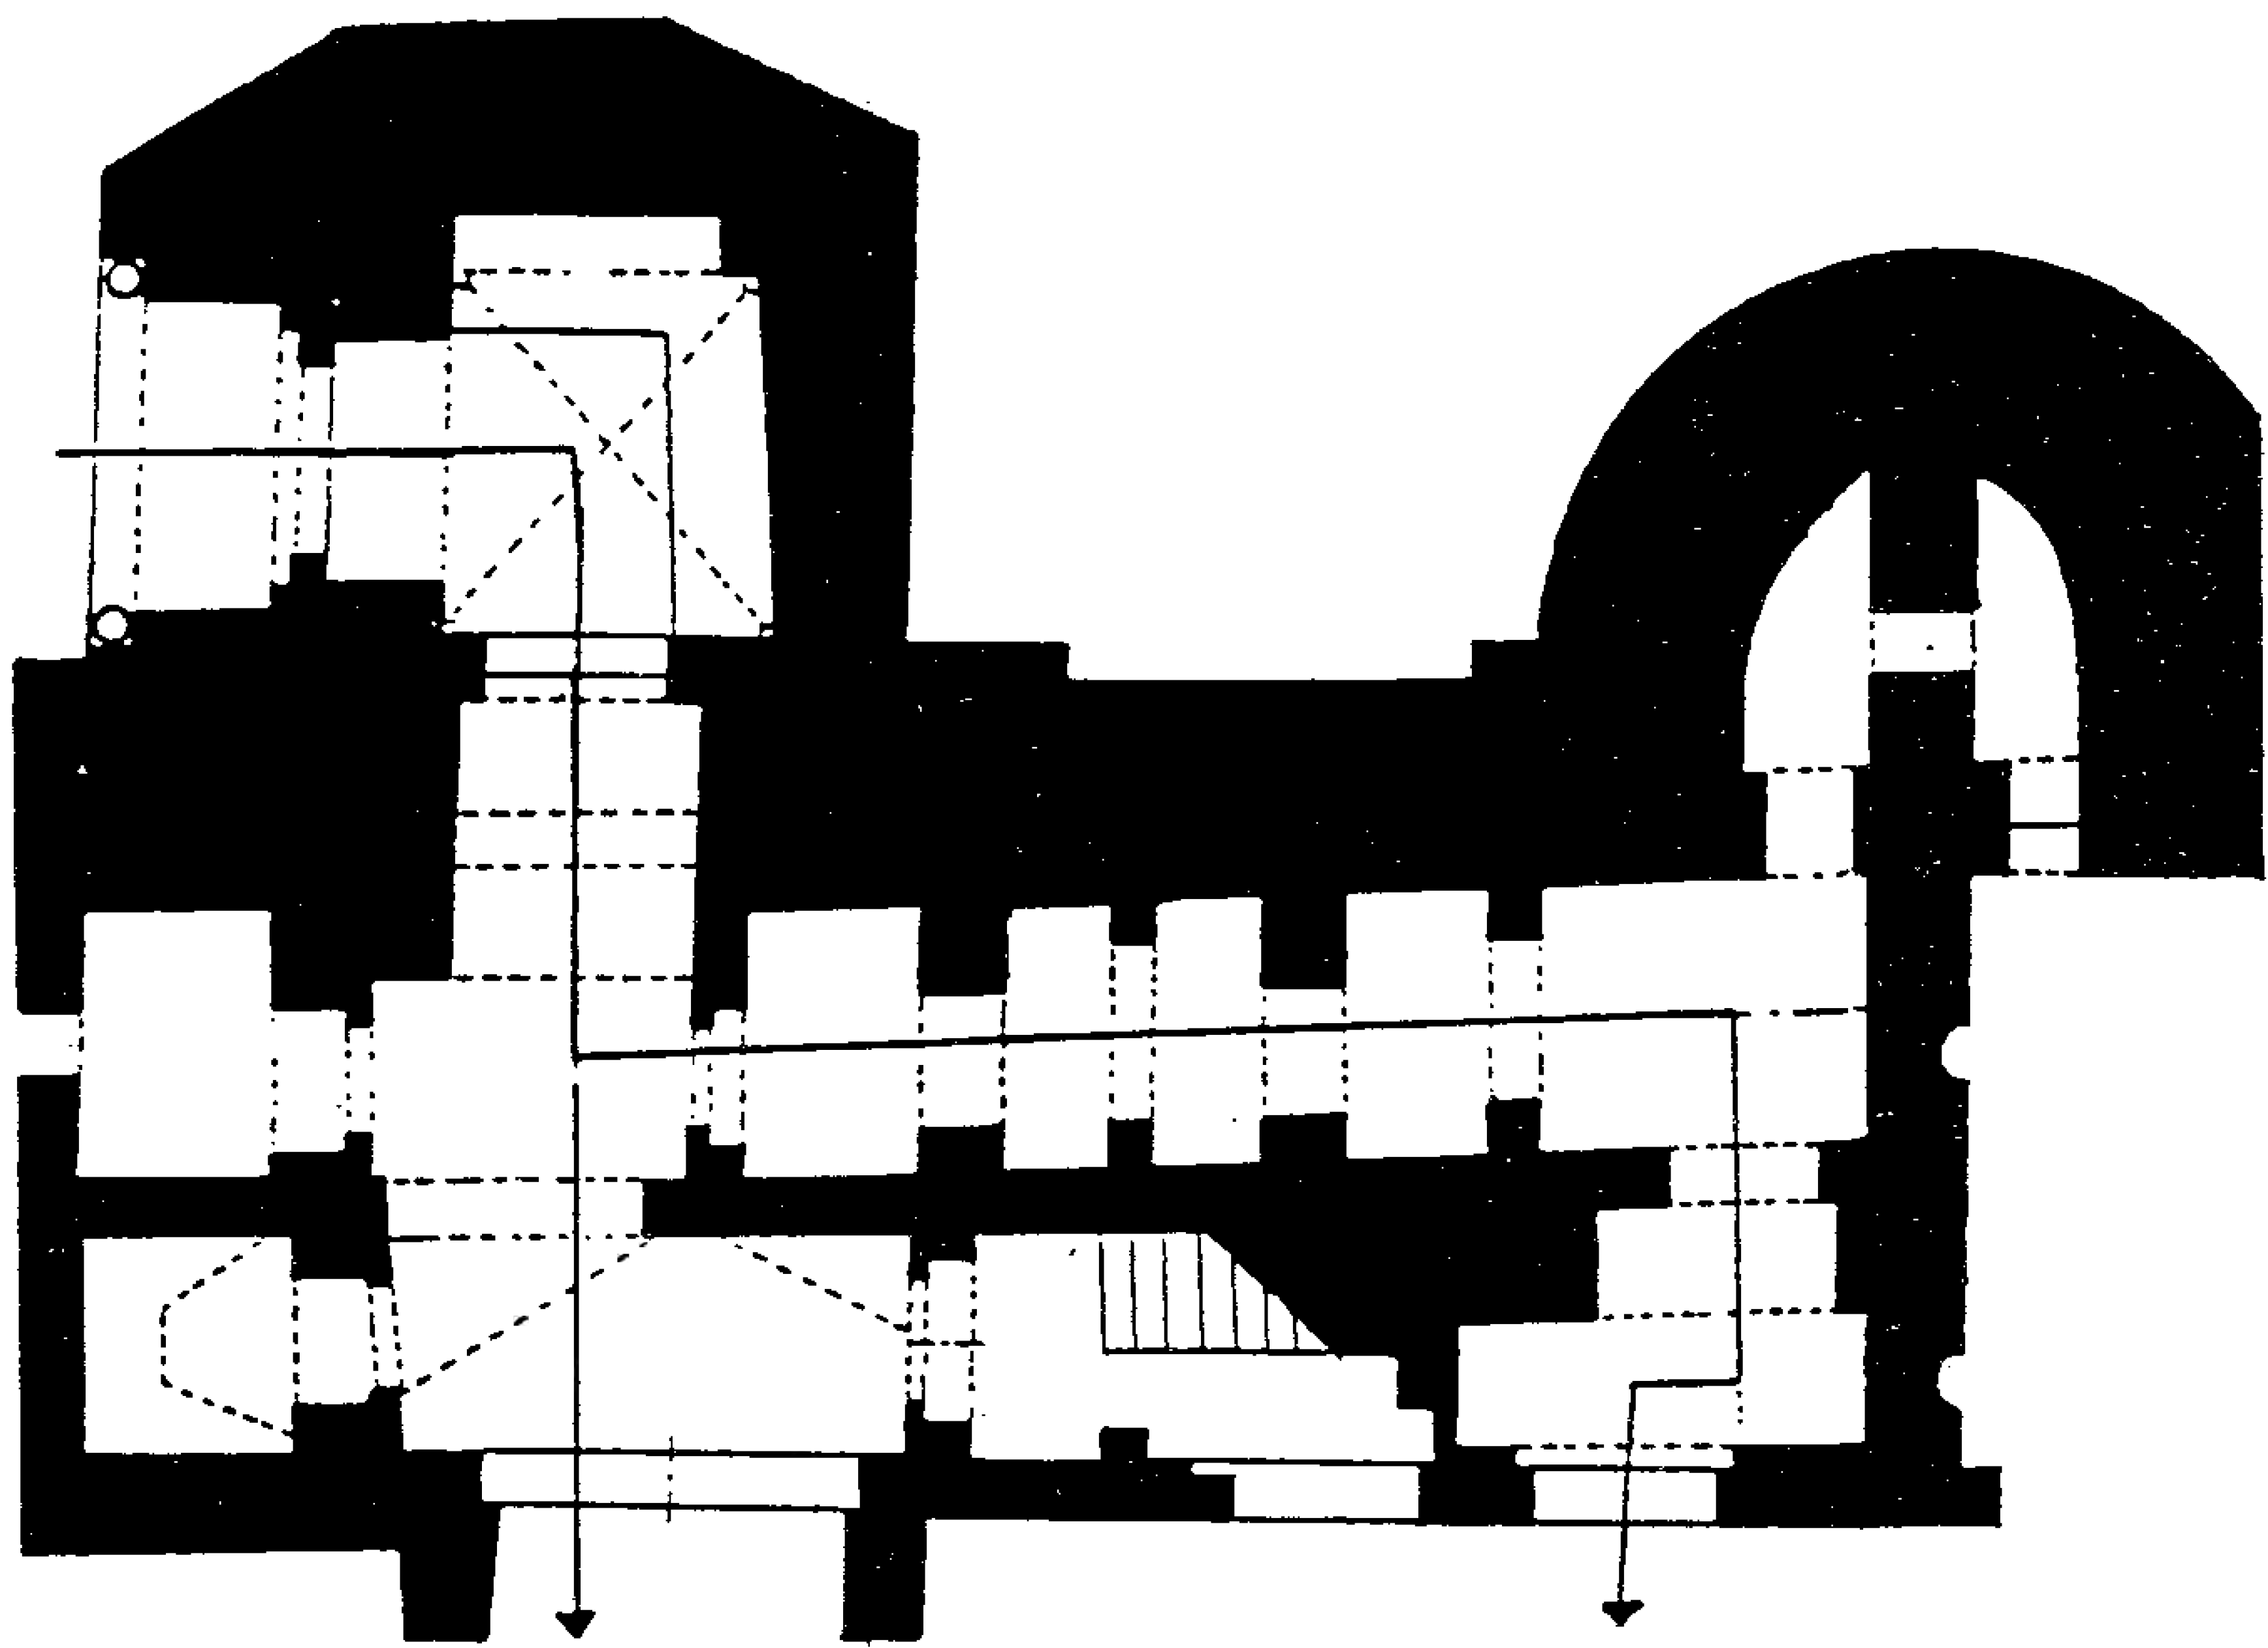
رباط هرثمة : مخطط الطابق الاول
